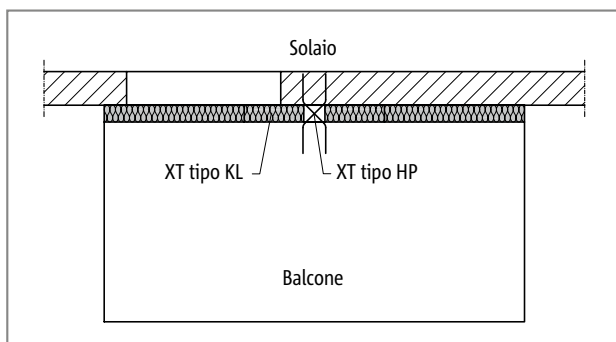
Schöck Isokorb® XT tipo KL: balcone a sbalzo; con elemento opzionale XT tipo H, in presenza di carichi orizzontali di progetto (p. es. balaustre chiuse)
